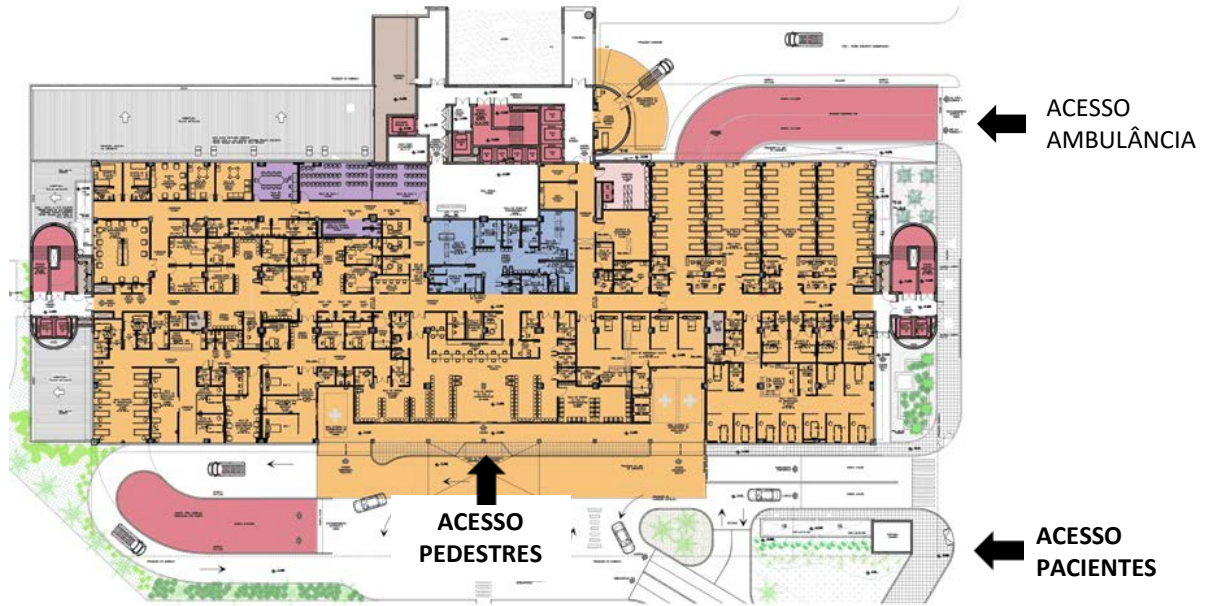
Anexo I - planta baixa do pavimento térreo. (Fonte: material de divulgação do projeto de ampliação do HCPA)
